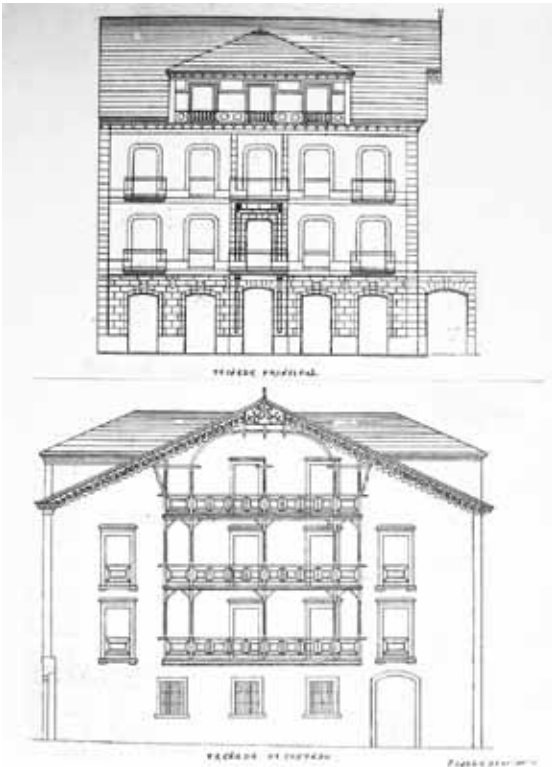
Edificio de la fonda La Boalesa, calle Santa Susana, Oviedo. (D)
